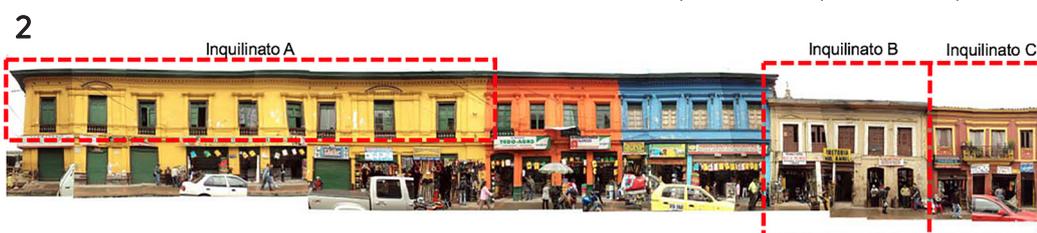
Fachadas inquilinatos, objeto de estudio (Fuente: Elaboración propia).
